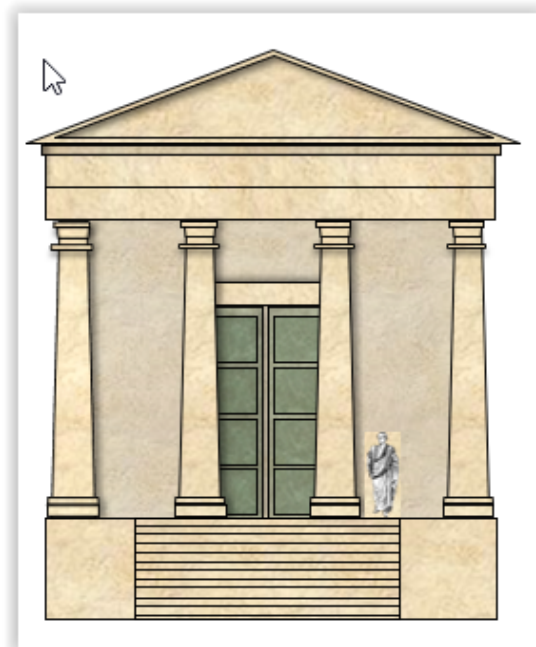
Façade du temple (dessin D. Lepoittevin)
